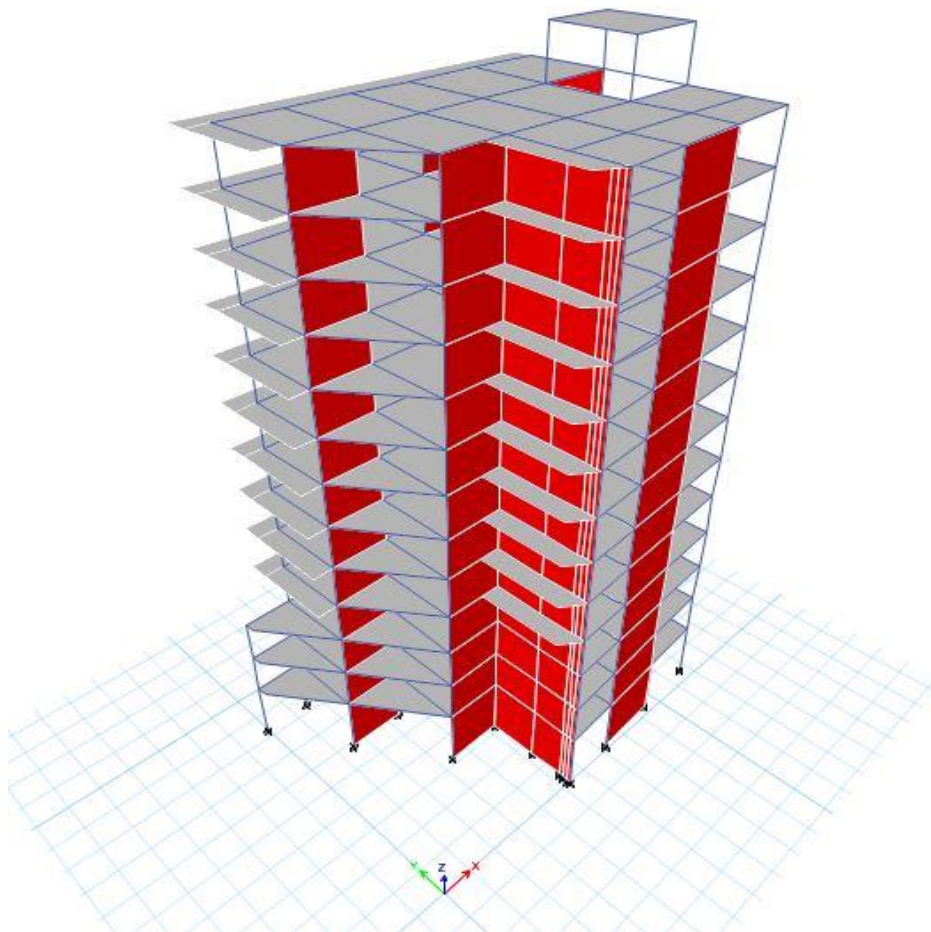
3D de la structure porteuse avec un contreventement mixte portiques-murs voiles
